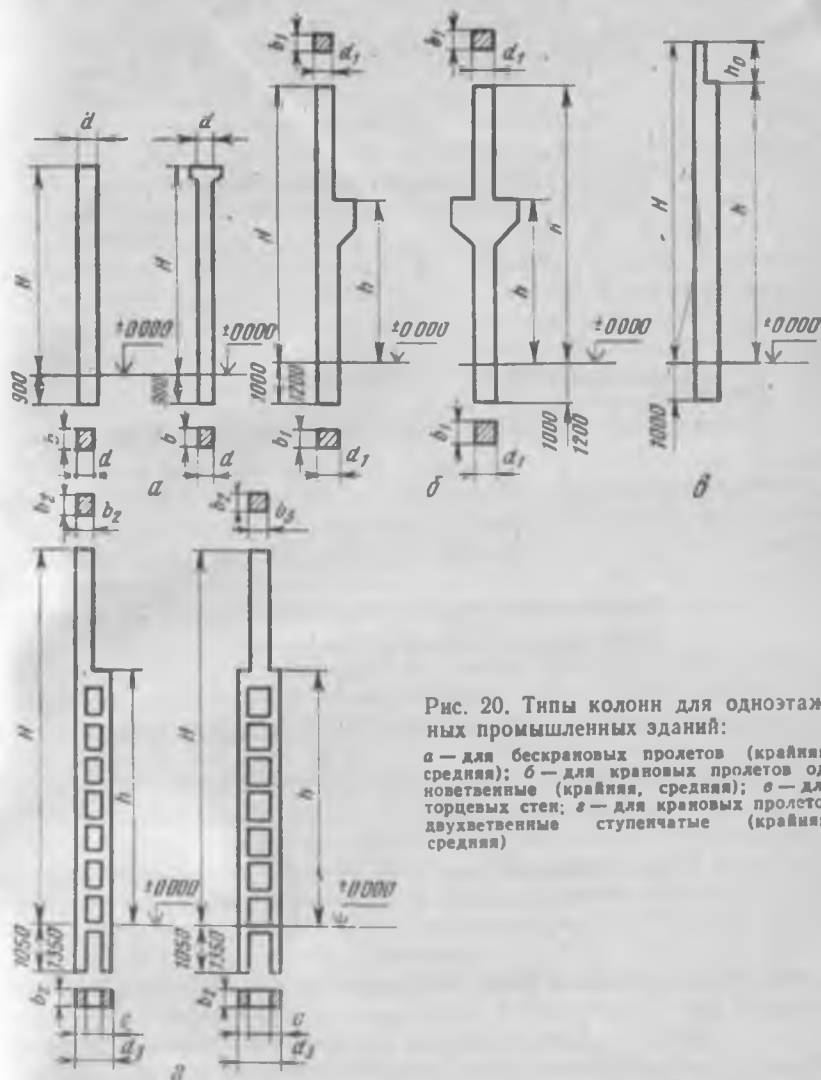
Типы колонн для одноэтажных промышленных зданий:
